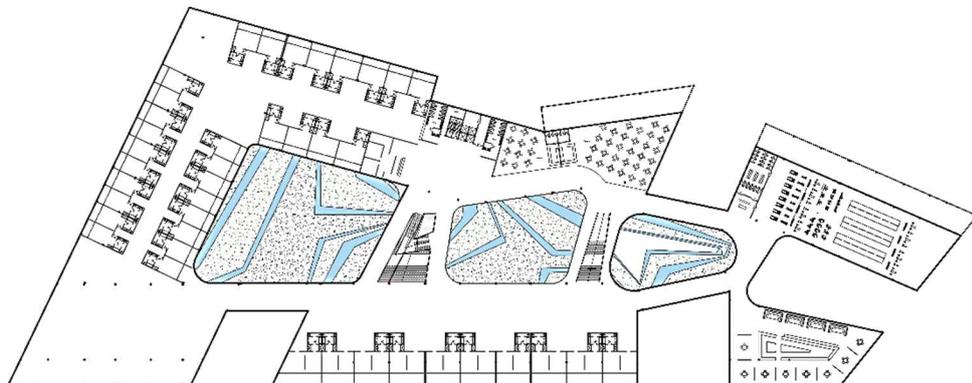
17 Plan étage R+5. Source :(Auteur, 2020)
